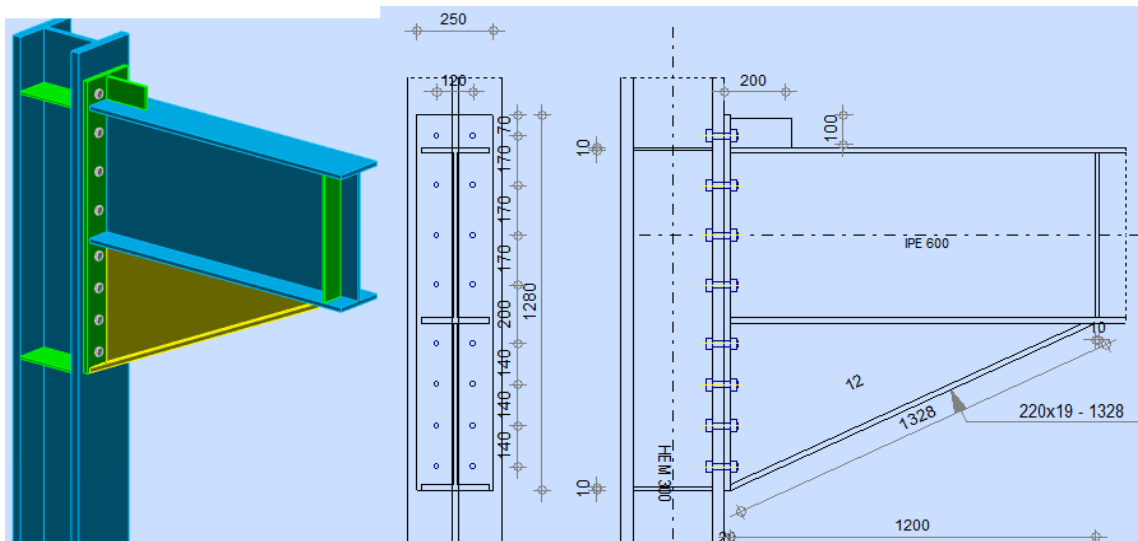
Représentation de l'assemblage poteau HEM 300 – poutre IPE 600
